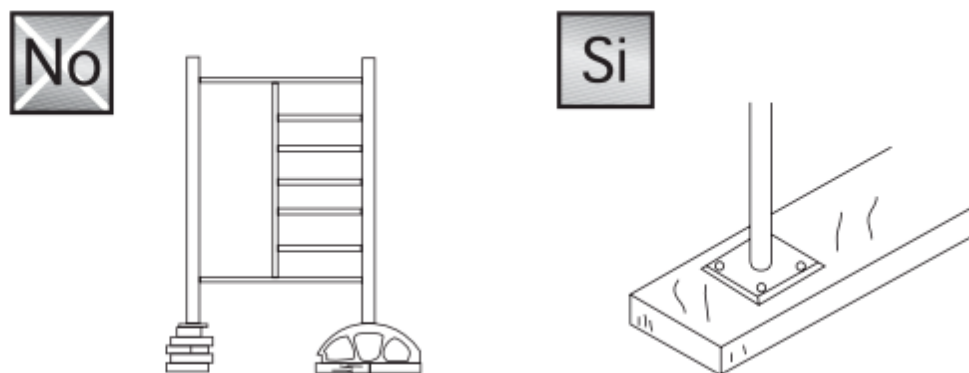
Apoyo correcto de andamios al suelo. Fuente: Nota Técnica trabajos en alturas, protección.
